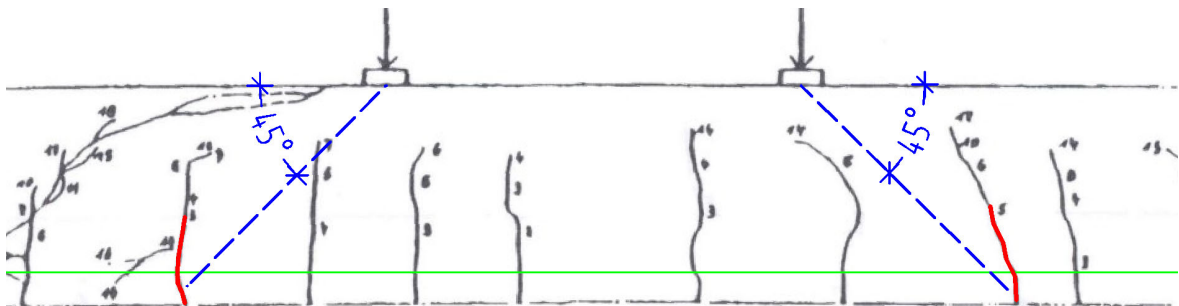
Risse im Kräfteinleitungsbereich des Balkens S 4.2
